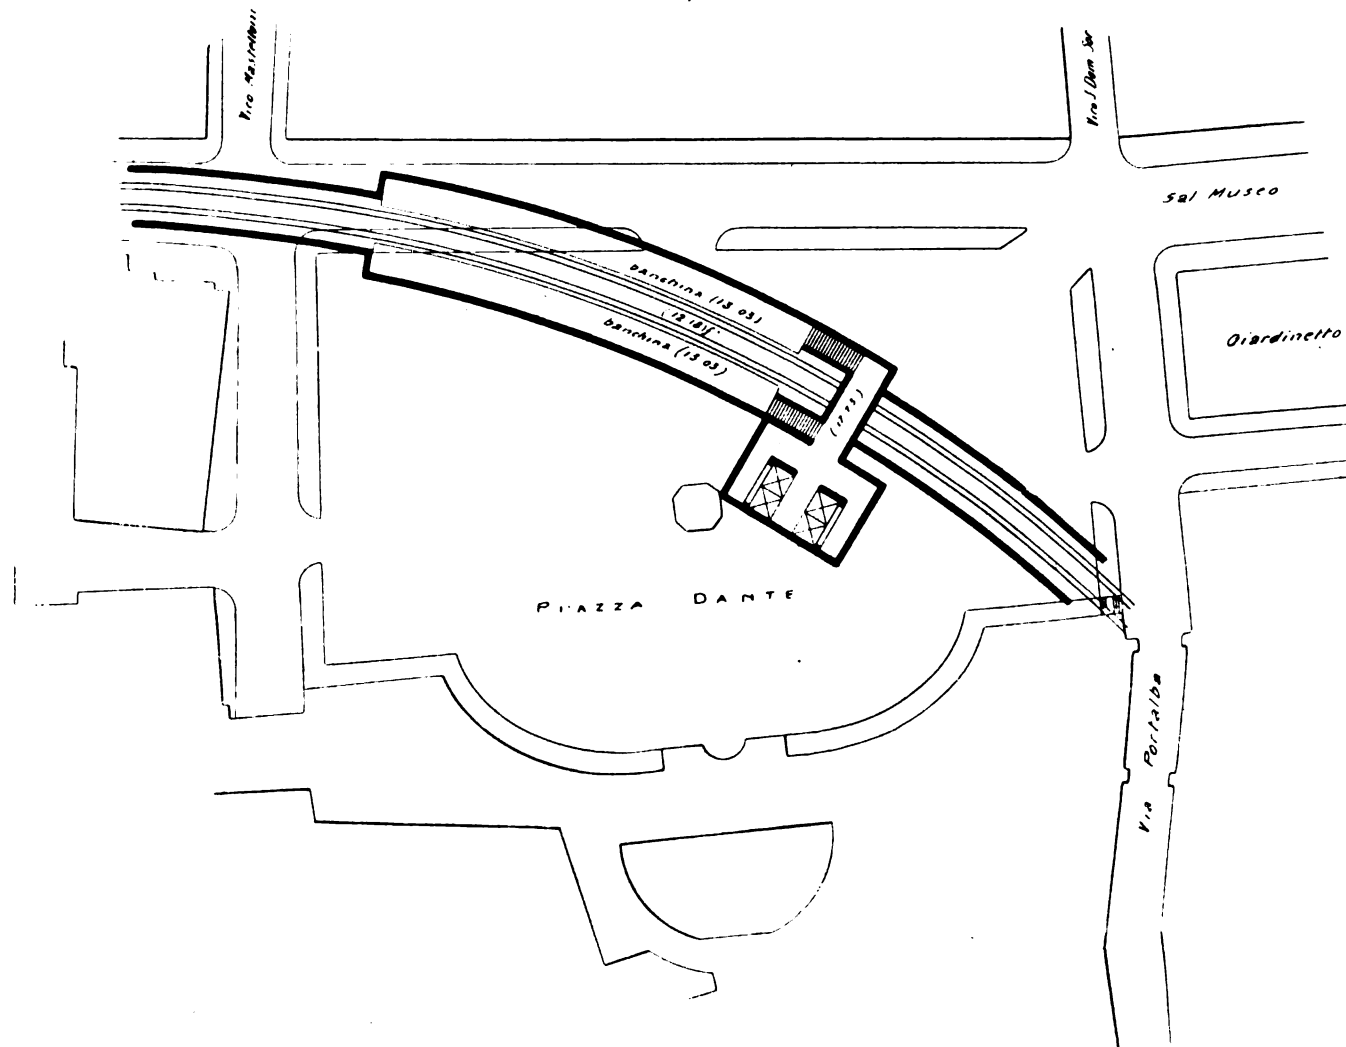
Stazione di Piazza Dante. - Pianta al piano delle banchine.
